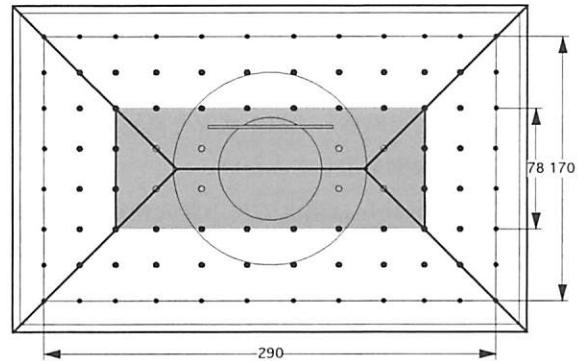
天平・鎌倉時の東大寺金堂平面図（単位は尺）
